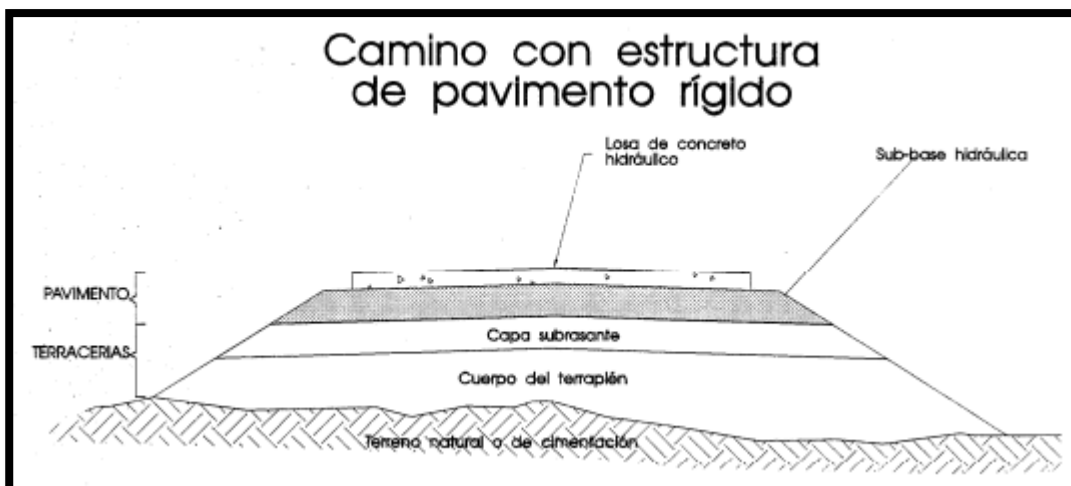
Esquema del sistema estructural de un pavimento rígido
